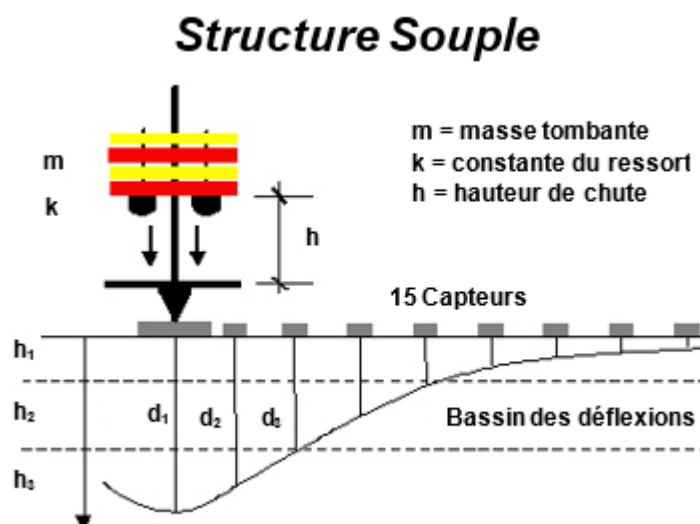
Principe de mesures du bassin de déflexions sur chaussées souples
